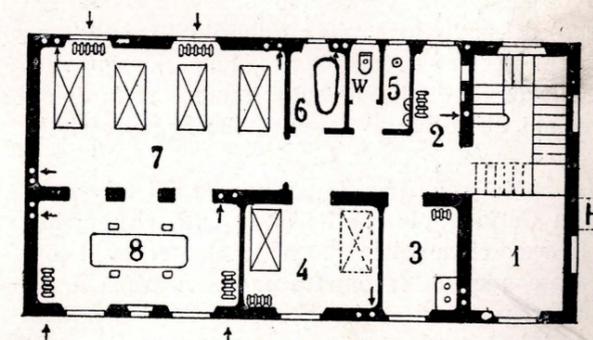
Pianta del secondo piano del padiglione (uomini).
